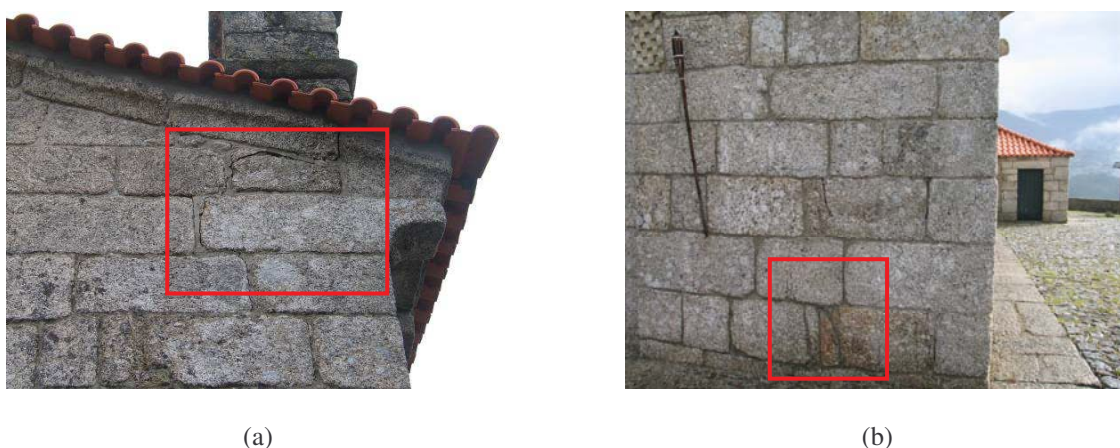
(a) Fissuração na fachada principal. (b) Fissura refechada na fachada principal.
